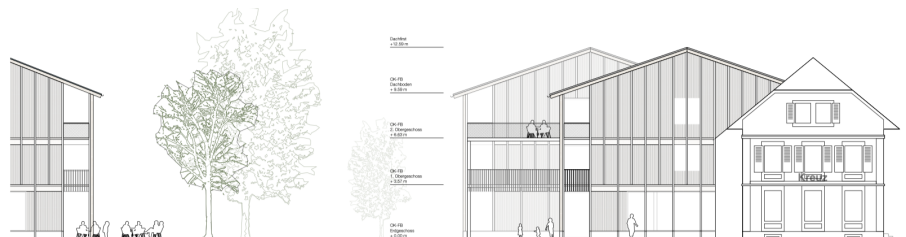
Fassadenansicht Seite Aarbergstrasse
